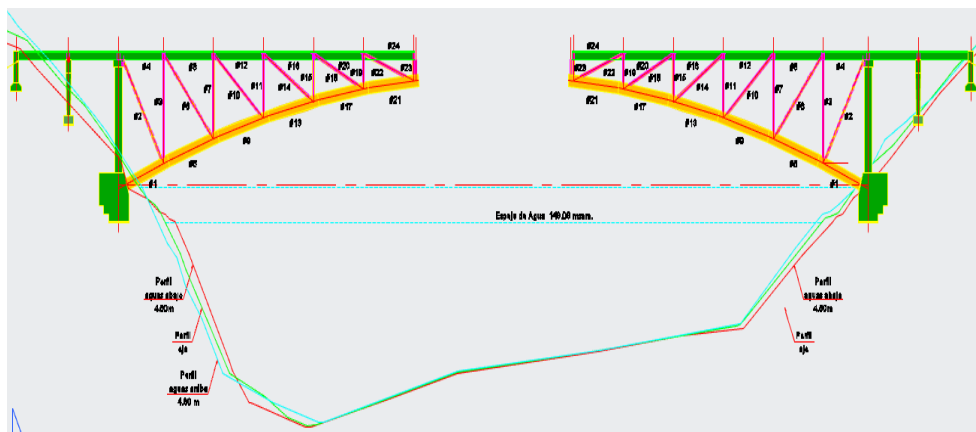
vaciado de la losa y postensado de la primera familia de cables
